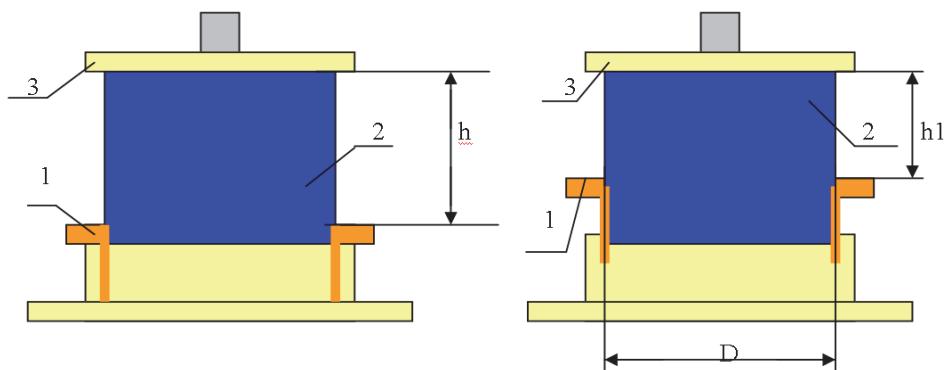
Схематичный разрез опоры с разным положением регулятора
